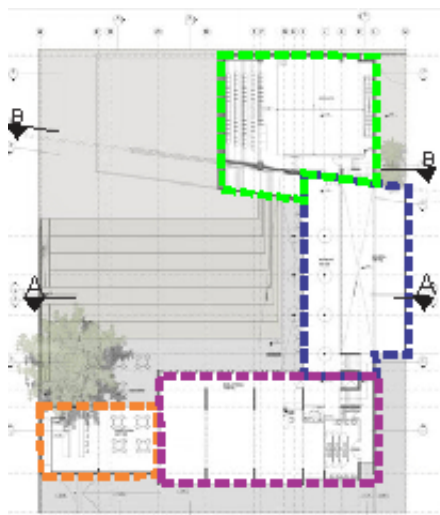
Pavimento Térreo de La Calera 01 Fonte: Aguirreyboza Adaptado Pela Autora
